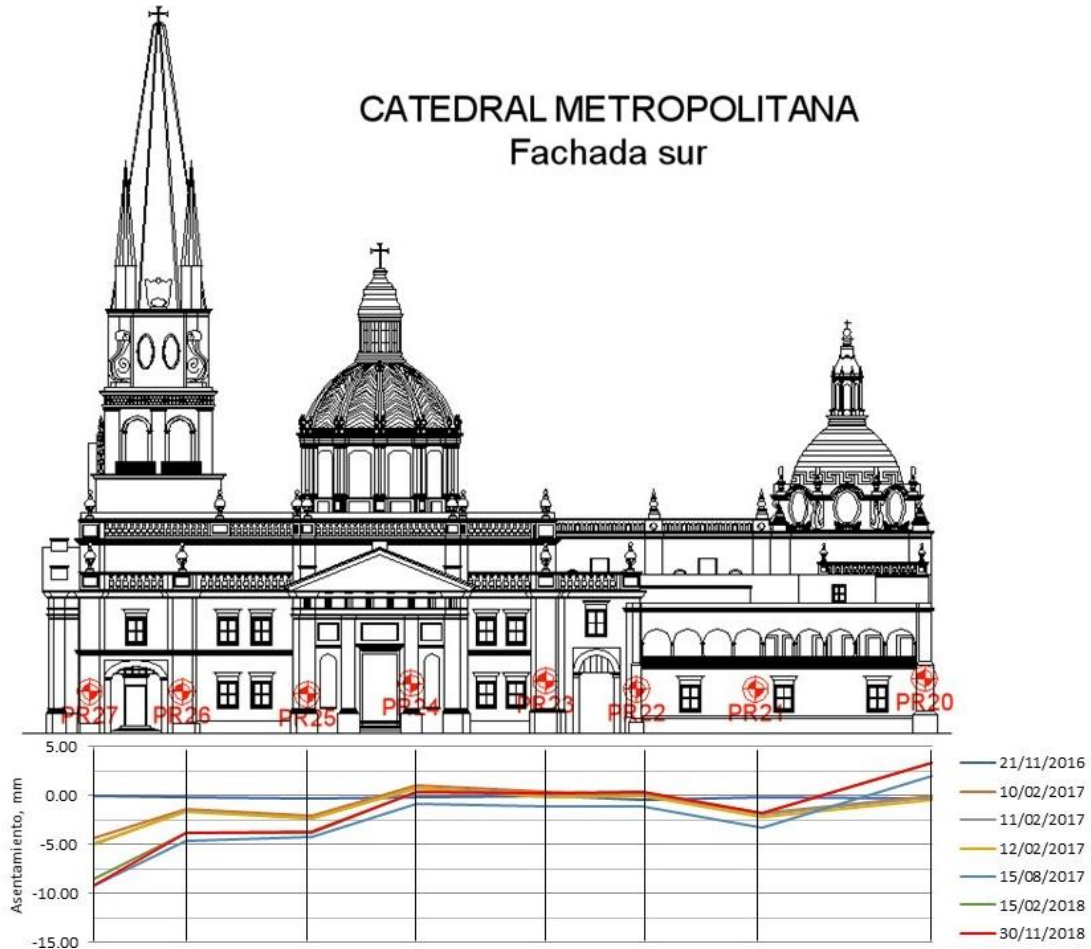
Perfil de asentamientos en la fachada sur. Sagrario Metropolitano.
